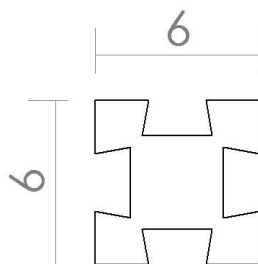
Perfil columna 15 cm x 15 cm alternativa 1
